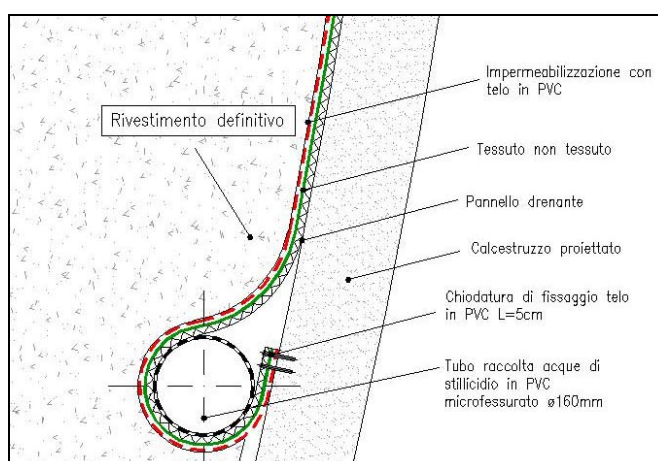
Sistema di drenaggio ed impermeabilizzazione n. 2.
